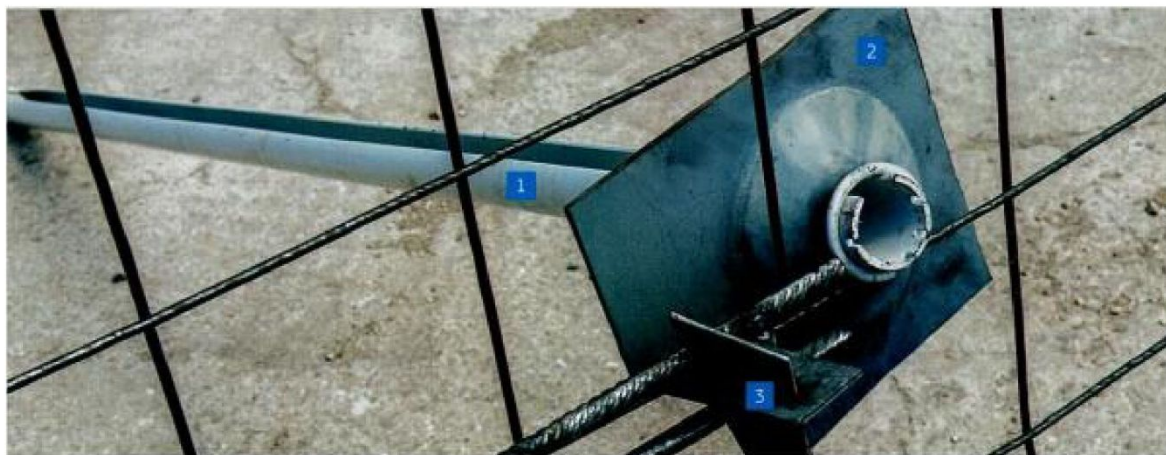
Конструкция СЗА–УКК для подвешивания металлической сетки
